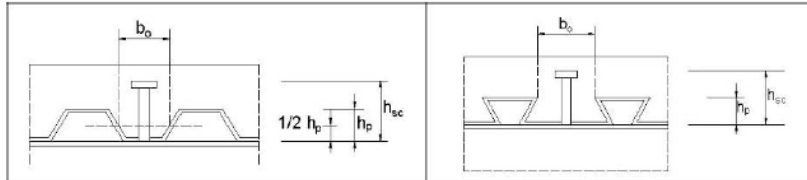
(b) - Disposizione della lamiera grecata rispetto al profilo in acciaio
